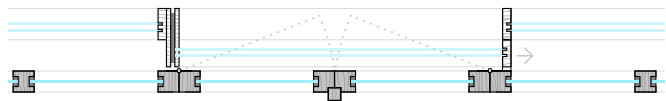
Sección constructiva 13 | Ventana dormitorio.
